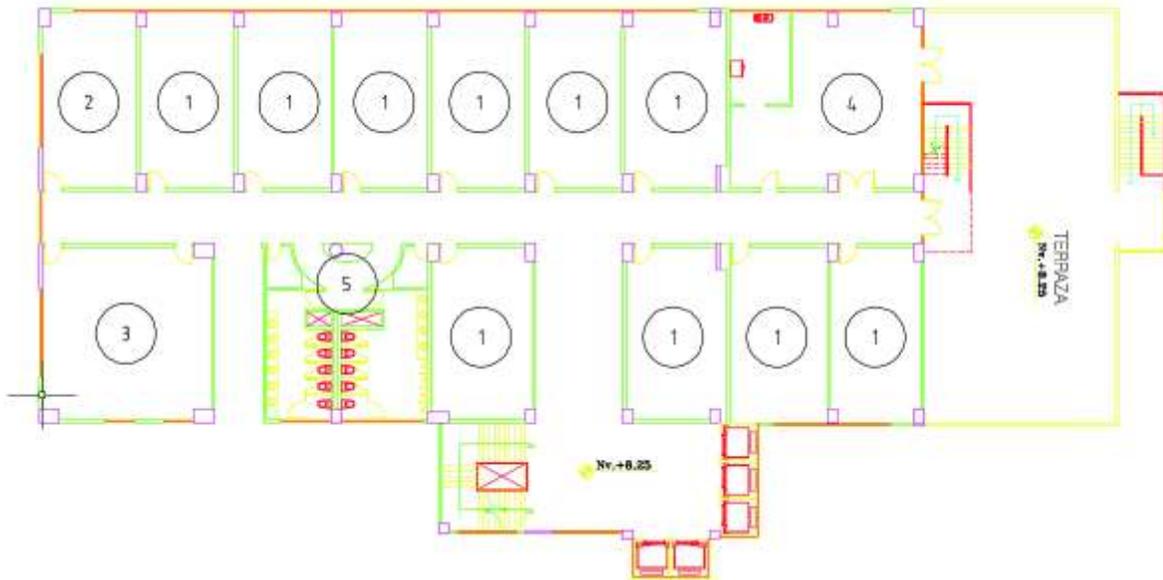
Distribución EARME primera etapa, Planta Segundo piso
